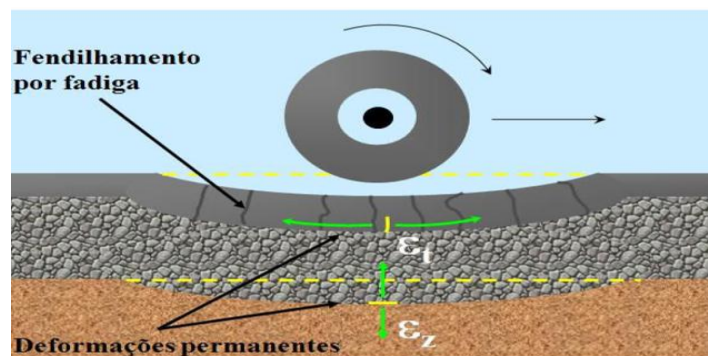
Deformações num pavimento flexível (REIS, 2009).
